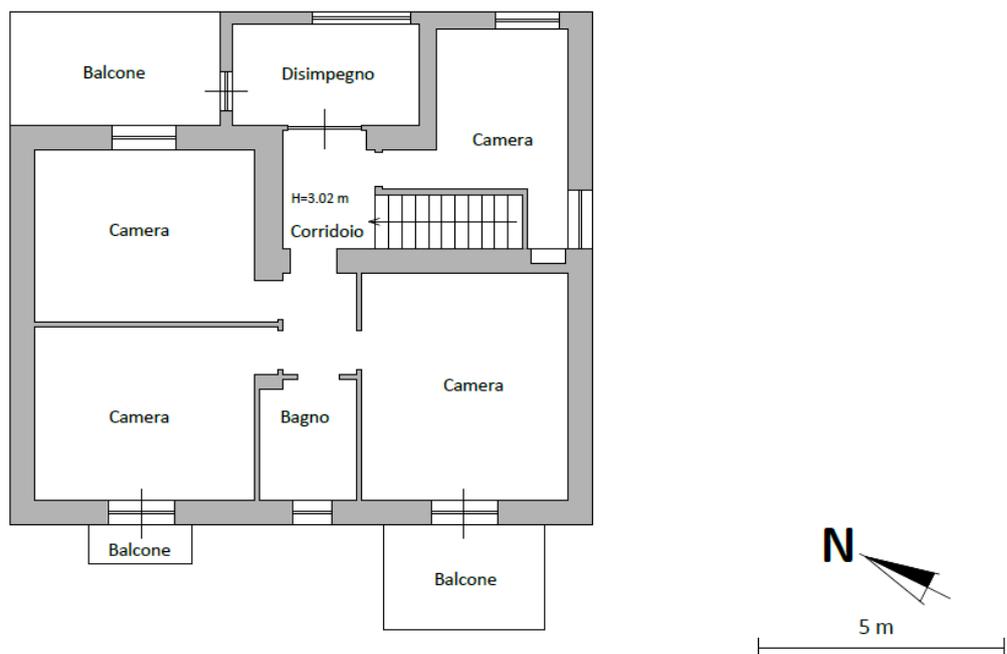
Planimetria dello stato reale dei luoghi - Piano 1°
